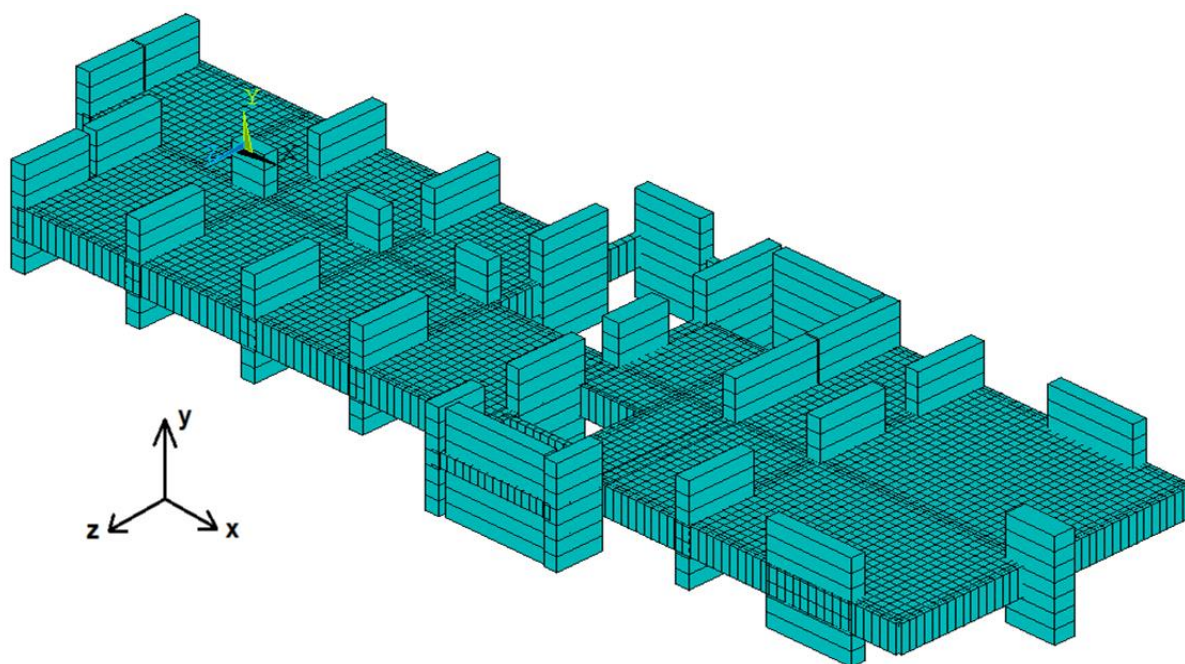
Perspectiva pavimento tipo em elementos finitos - Modelo 140 metros.
